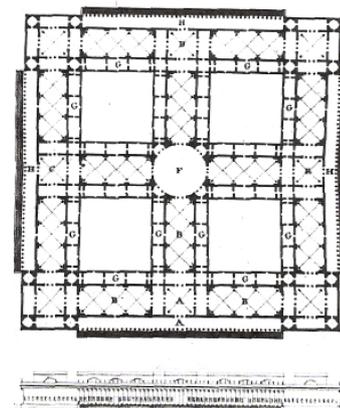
Planta e fachada do Museu de Durand, 1802-1809.
